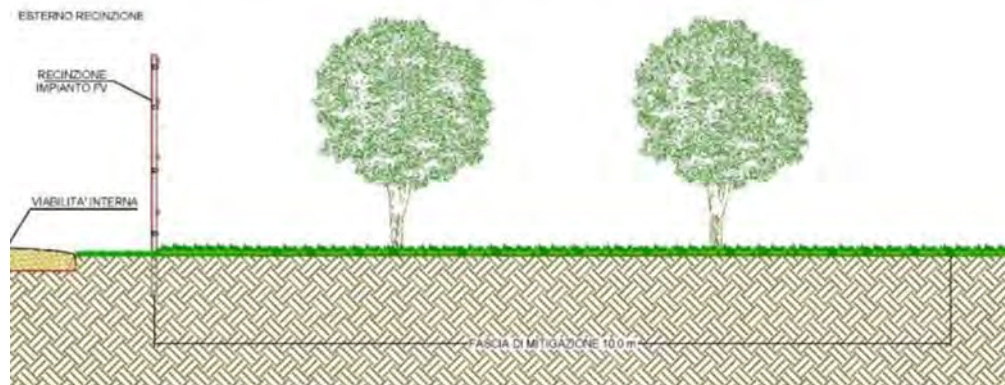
Sezione tipologica fascia di mitigazione perimetrale
